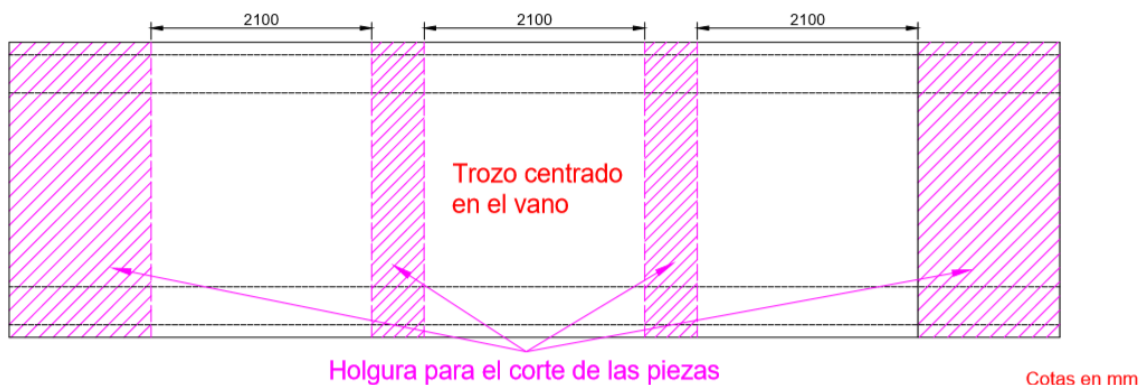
Corte de la sección longitudinal segunda propuesta con daños en los extremos
